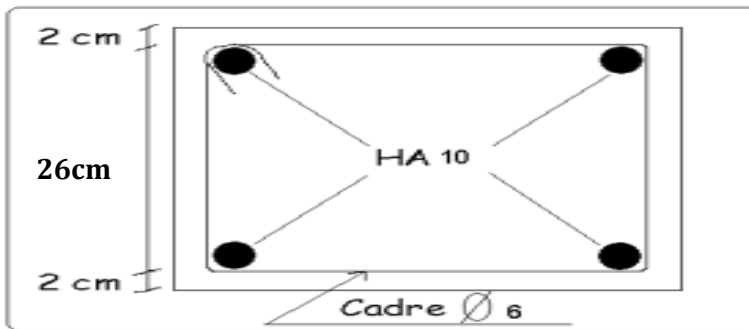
9 : Schéma de ferrailage de la poutre de chaînage.
